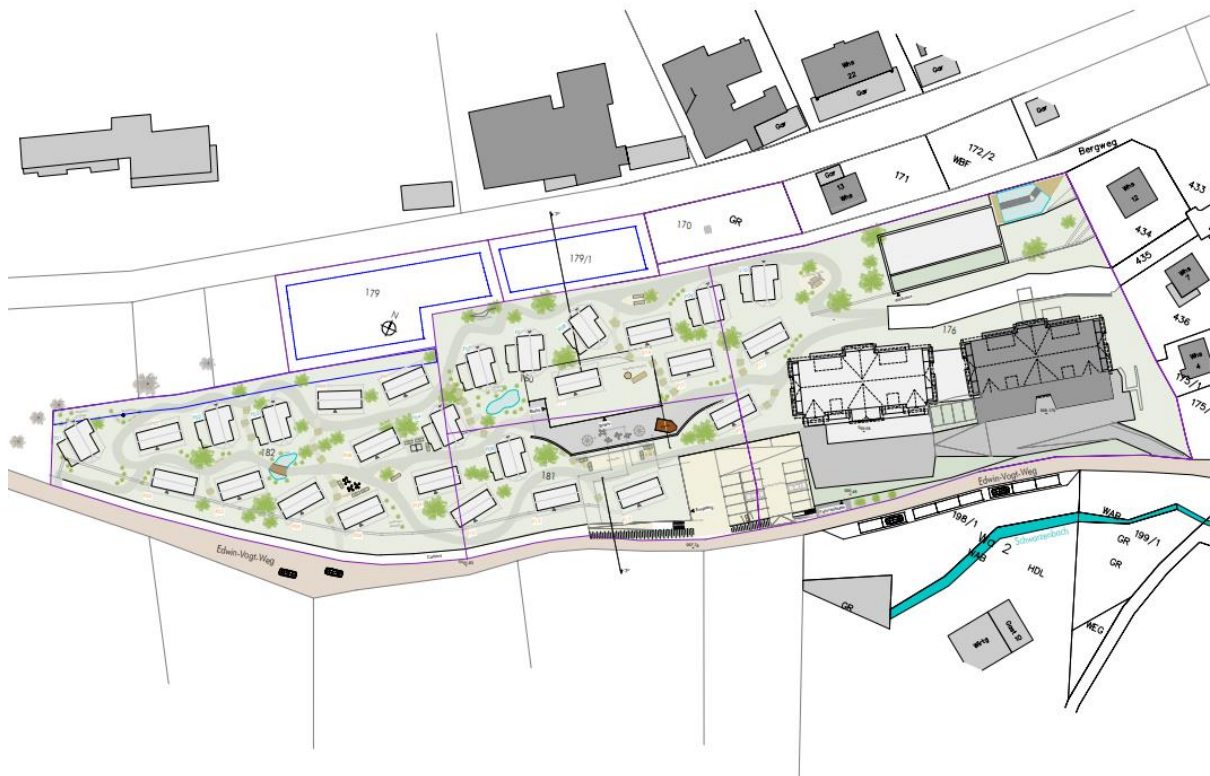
Lageplan des Bebauungsplans (Architekturbüro SENNRICH & SCHNEIDER).
